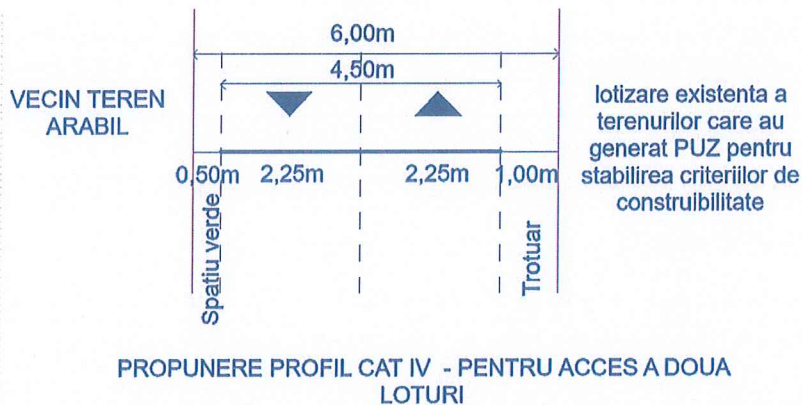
Propunere profil stradal pentru acces la cele doua loturi existente, cu acces din str. Martisorului
